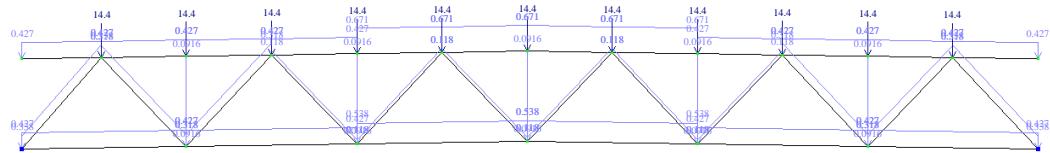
Загружение №1: постоянная узловая нагрузка и собственный вес фермы
